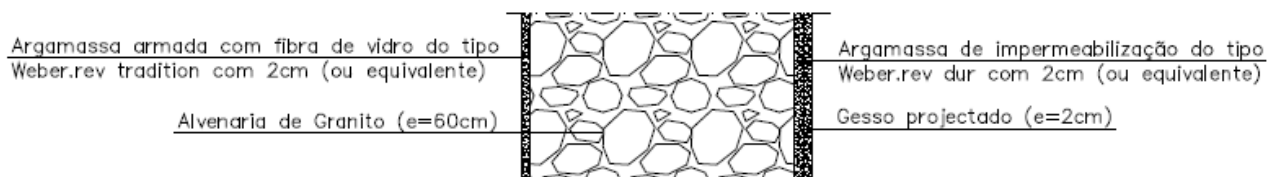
Pormenor construtivo das paredes de empena (piso 4 + recuado) (Projeto de CT)
